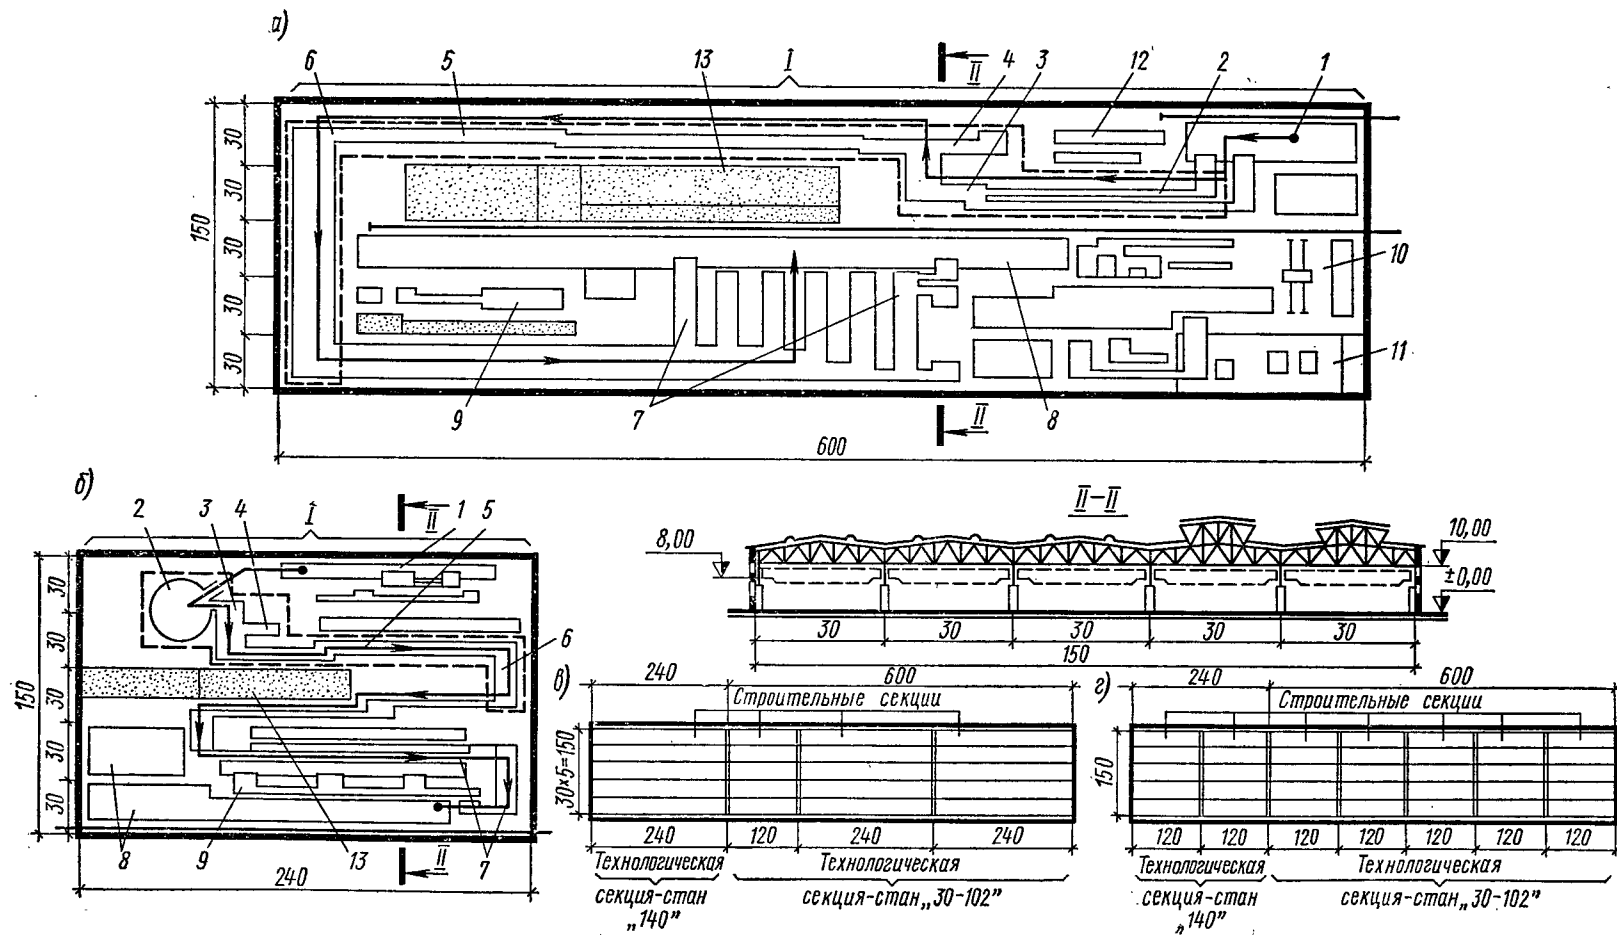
Варианты схем планировок трубных цехов на основе секций:
